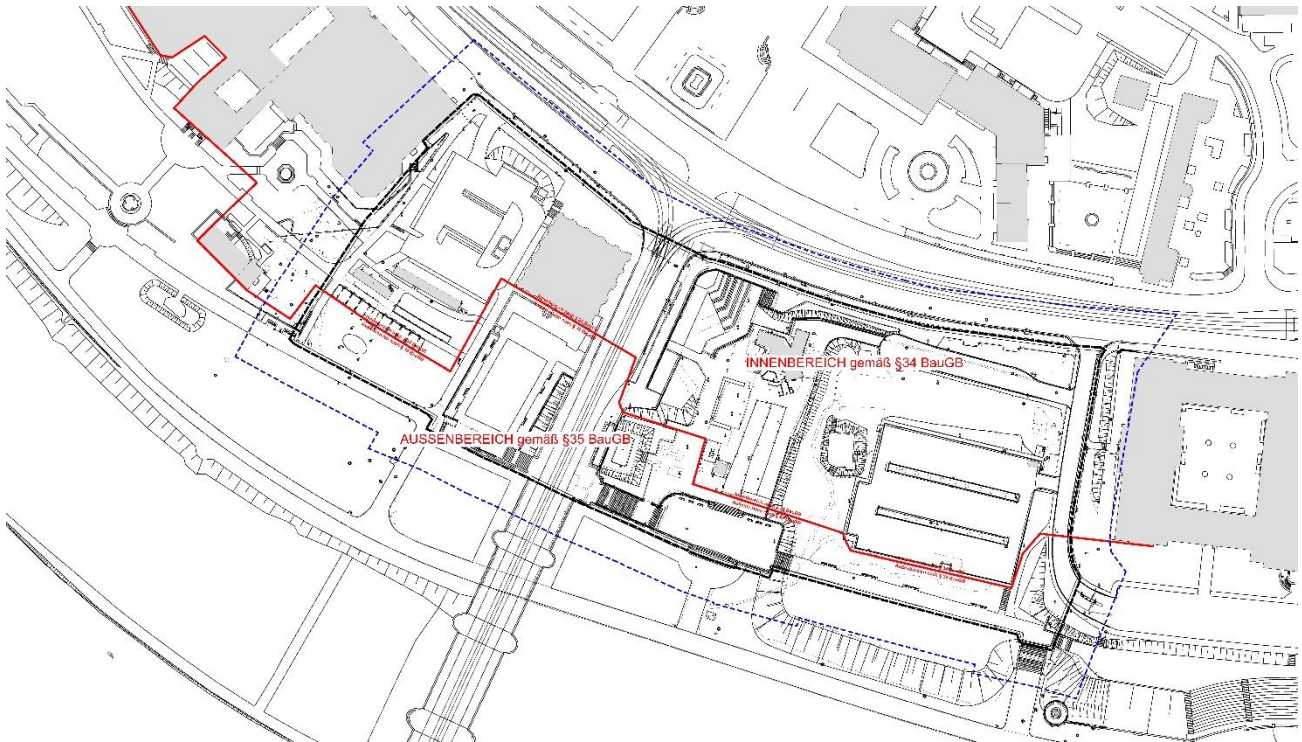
Abgrenzung Innenbereich gemäß §34 BauGB und Außenbereich gemäß §35 BauGB (rote Linie), erweiterter Betrachtungsraum (blaue Linie)
